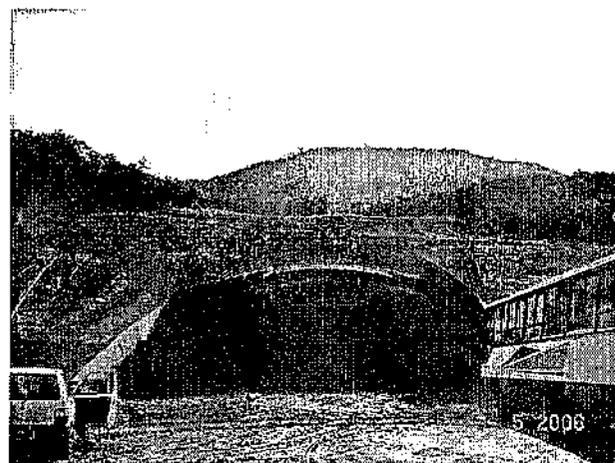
vista lateral da área suprimida, emboque sul, lote 03/RSI
